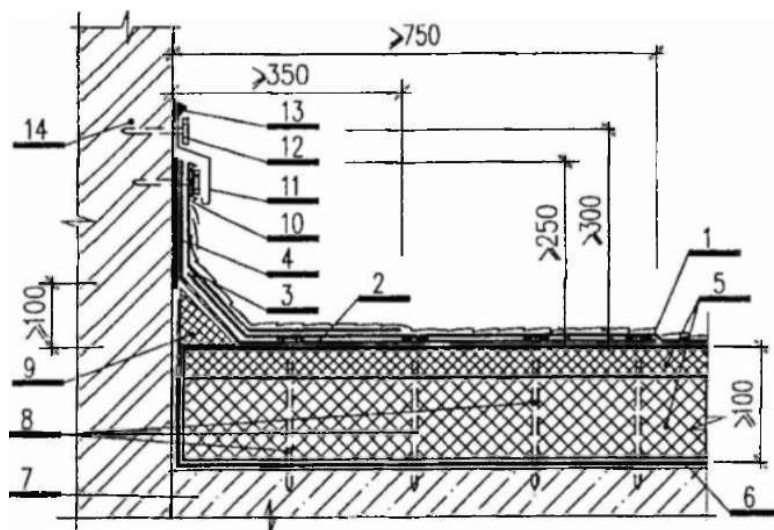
Примыканиеоднослойной кровли по плитному (двухслойному) утеплителю с механическим креплением к несущей конструкции (дюбели показаны условно)
